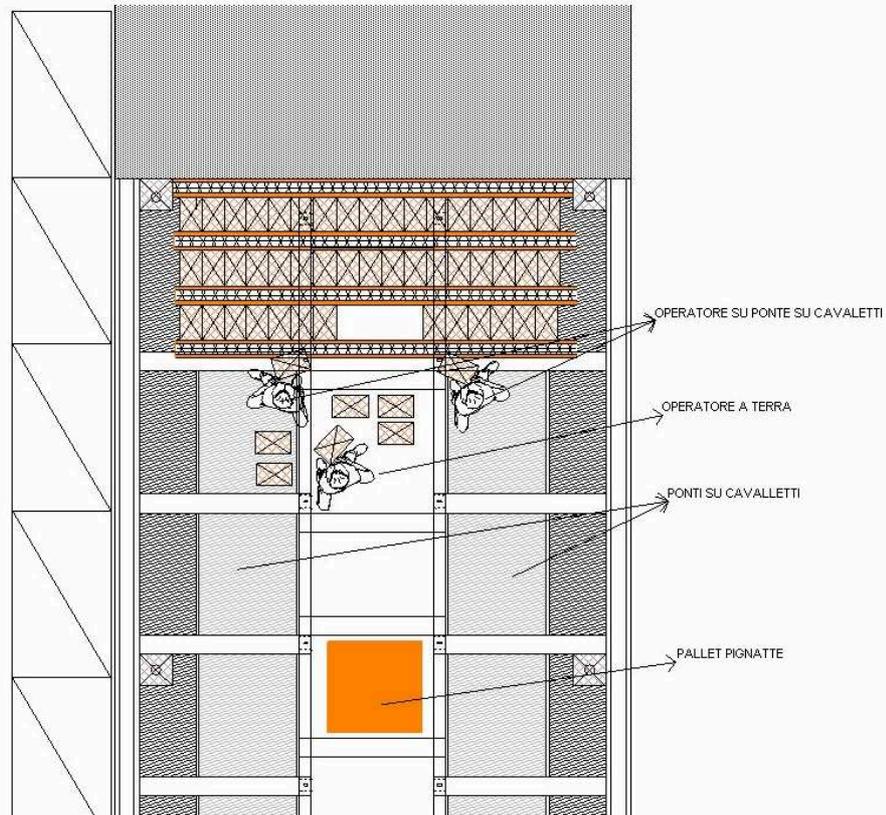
posa travetti e pignatte dal piano sottostante il solaio – vista planimetrica
